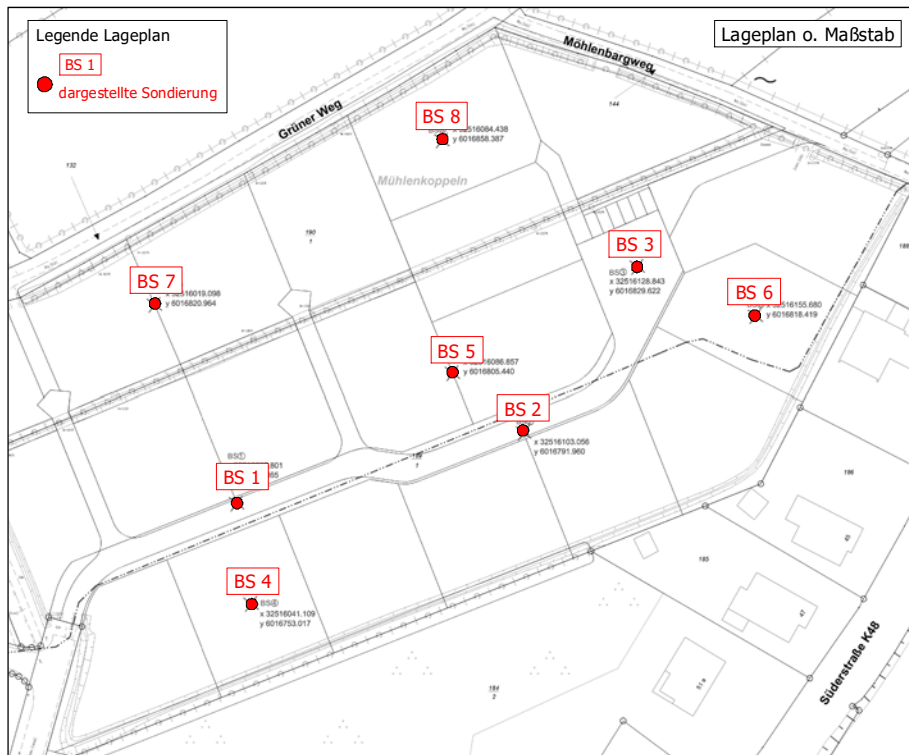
Ausschnitt Lageplan Anl. 1.1 (o. M.)
